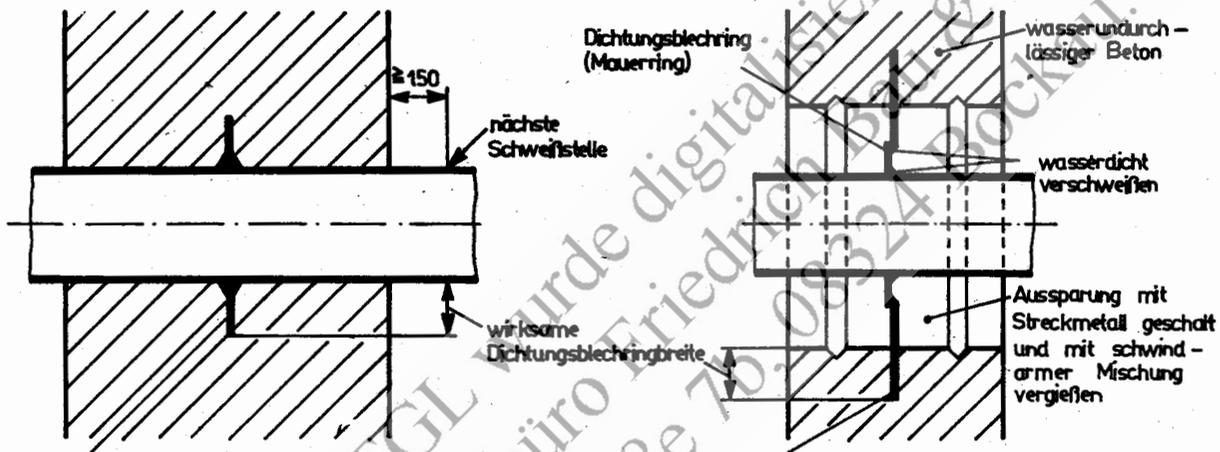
Möglichkeiten der Anwendung wasserundurchlässiger Beton- und Mauerwerkskörper
